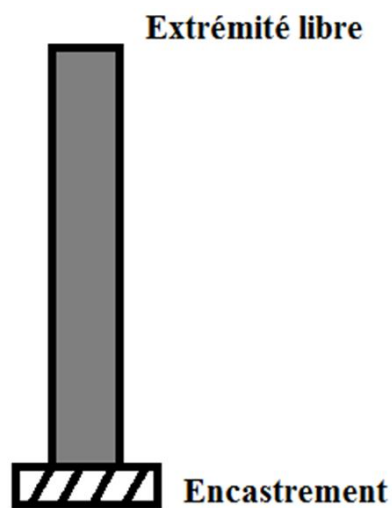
Représentation du rideau sous forme de poutre cantilever
